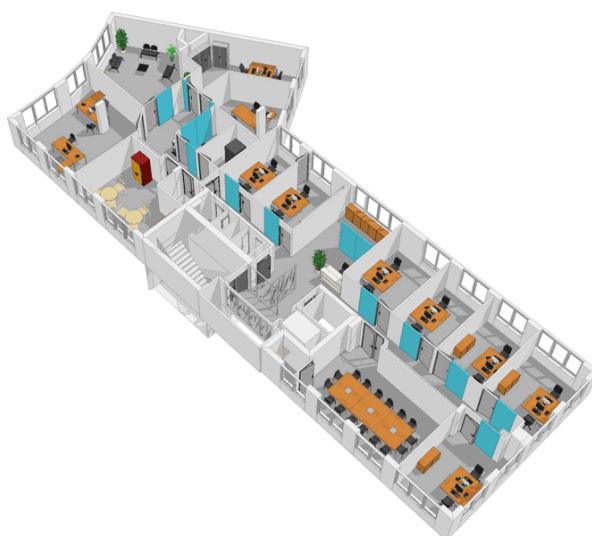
Plan type d'un plateau de bureaux¹¹².
